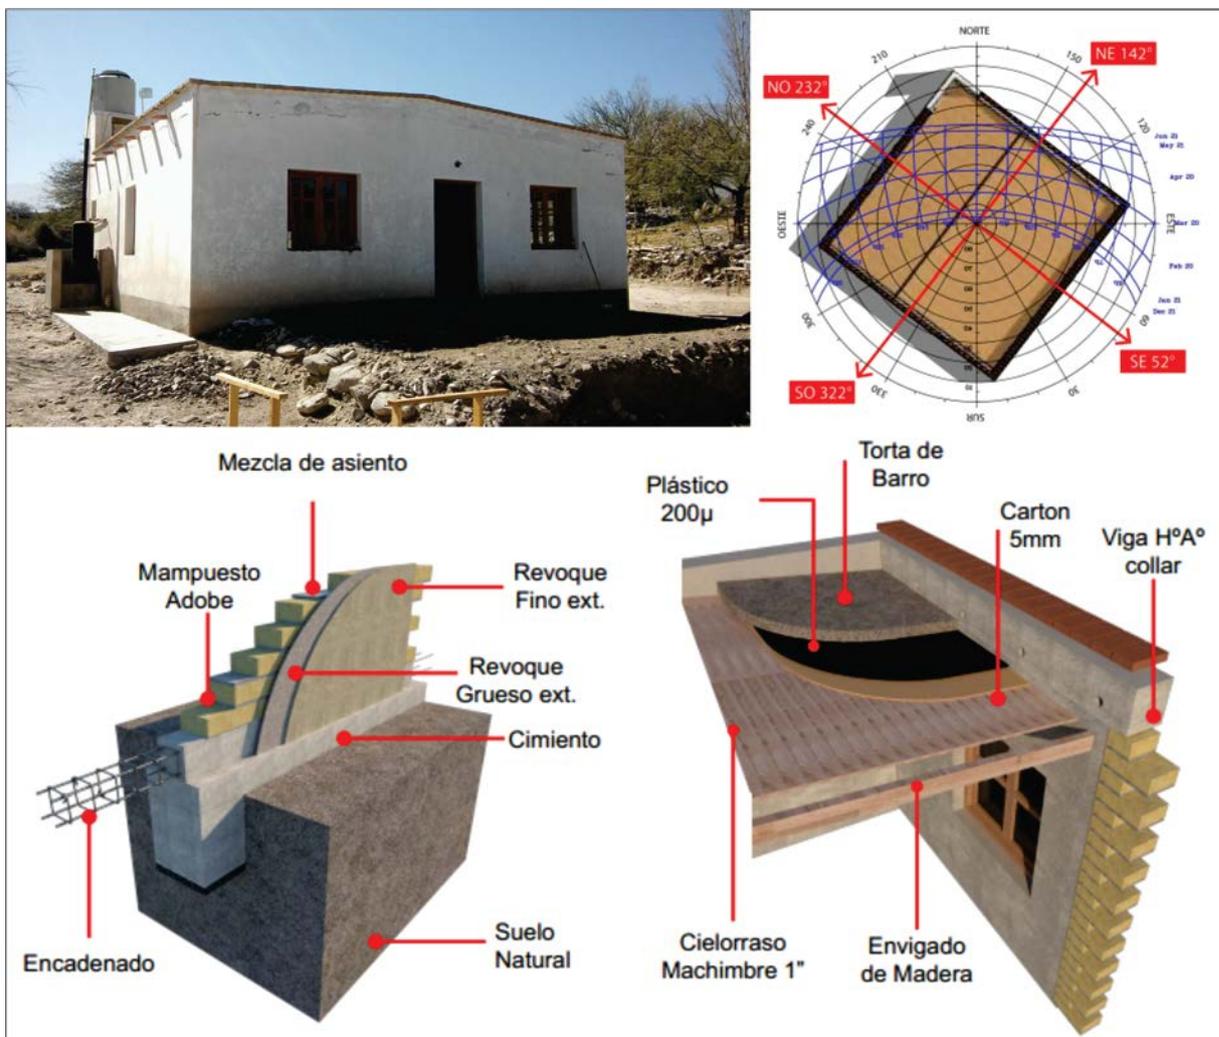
Imagen de la casa en estudio, su posición en el lote y detalles constructivos
